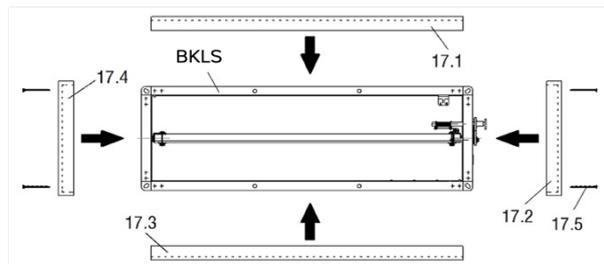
BKLS mit Einbaurahmen Typ ER-P1 (lose)
